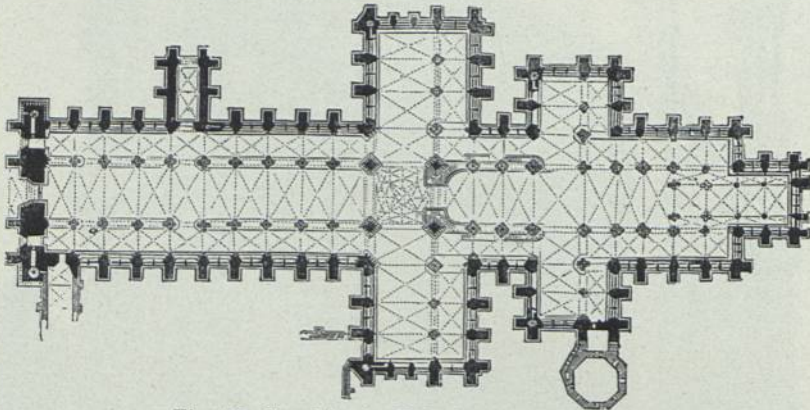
Grundriss der Kathedrale von Salisbury
